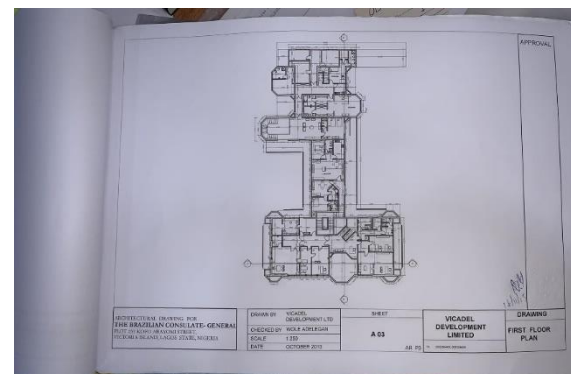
Planta baixa do primeiro pavimento. Fonte: Cedido pelo Consulado-Geral em Lagos.
